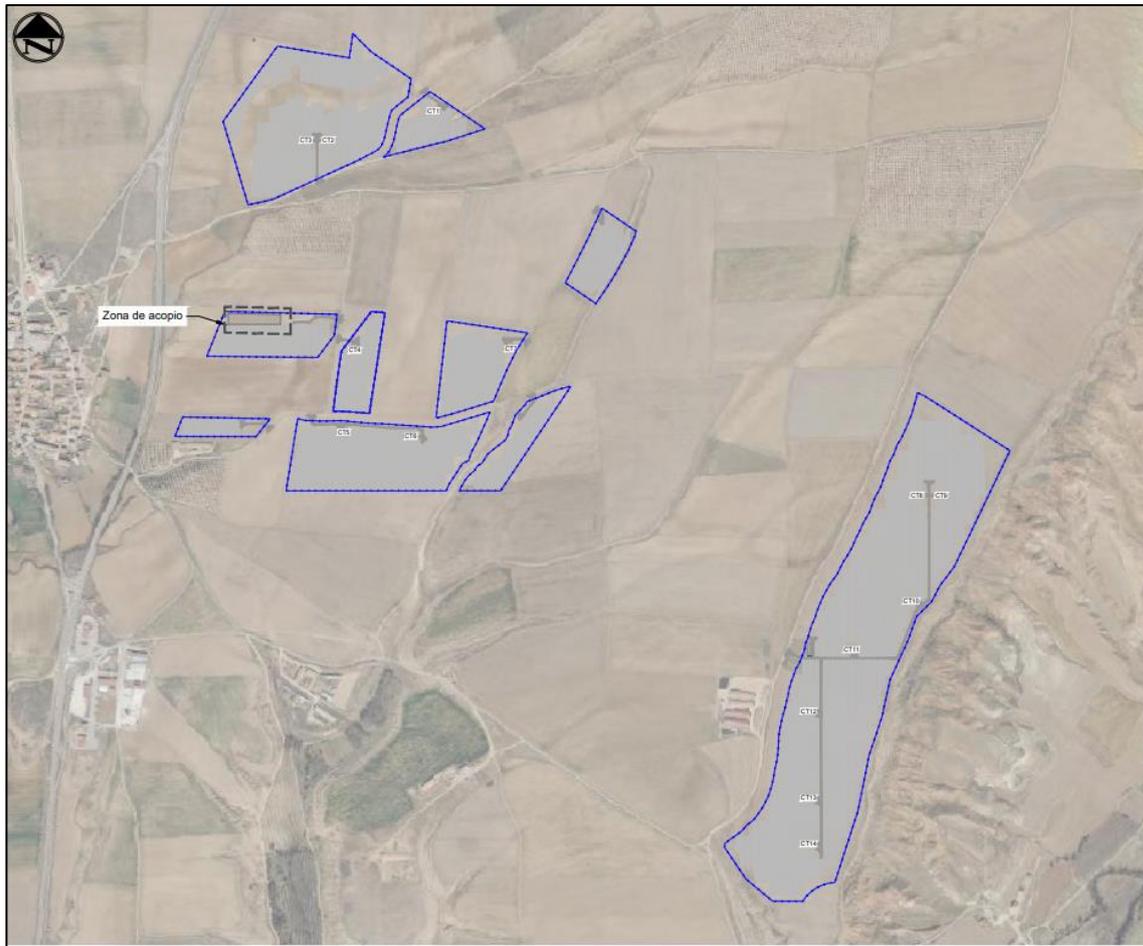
Zonas de acopio en el PFV San Peirón I. Fuente: Proyecto modificado de la planta fotovoltaica San Peirón I.
